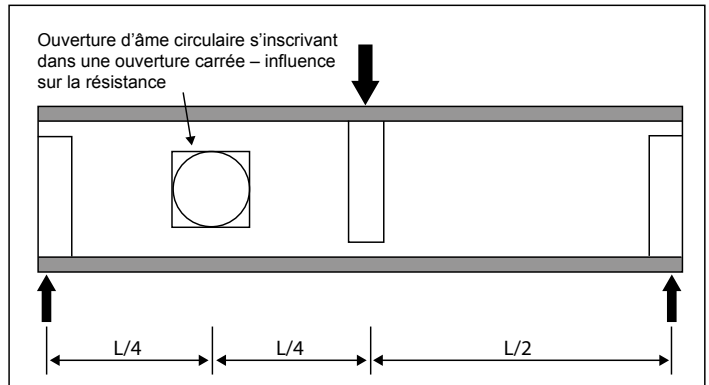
Banc d'essai de cisaillement de l'ouverture d'âme d'une poutrelle en I
